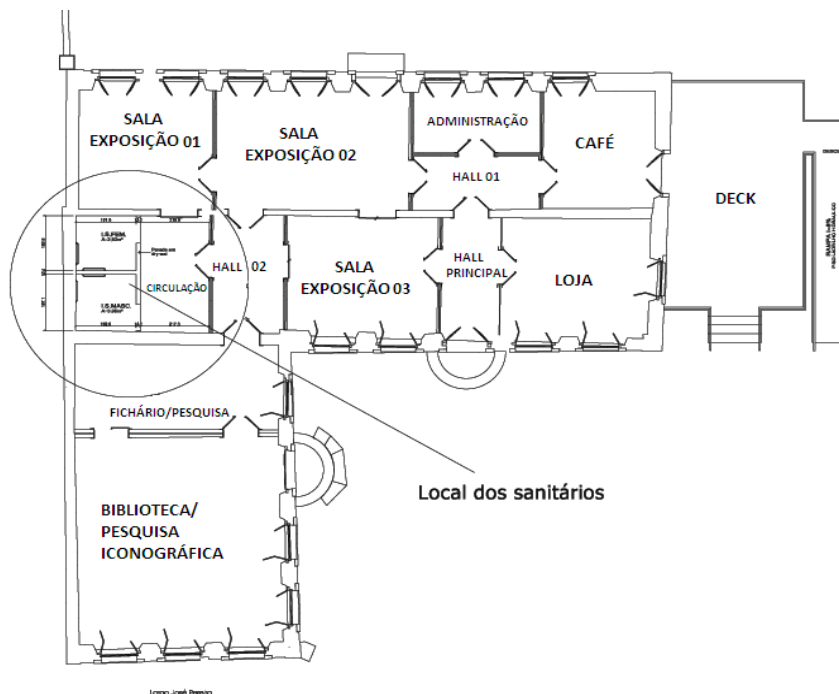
Planta baixa do restauro da área interna do bem tombado Casa Rocha Pombo.
